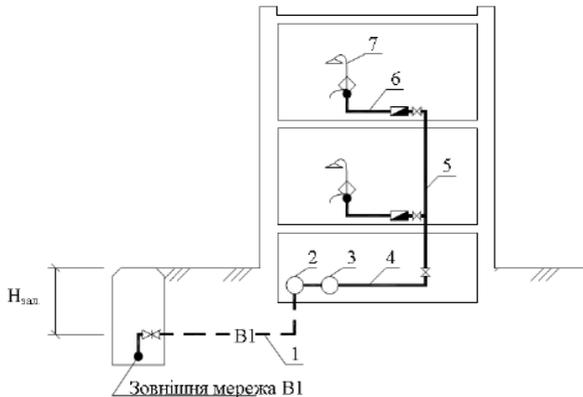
Умовна схема внутрішнього водопроводу:
